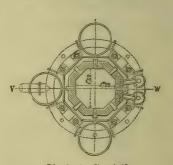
Grundriß. Achtförmiger Schachtofen (Sochofen)
